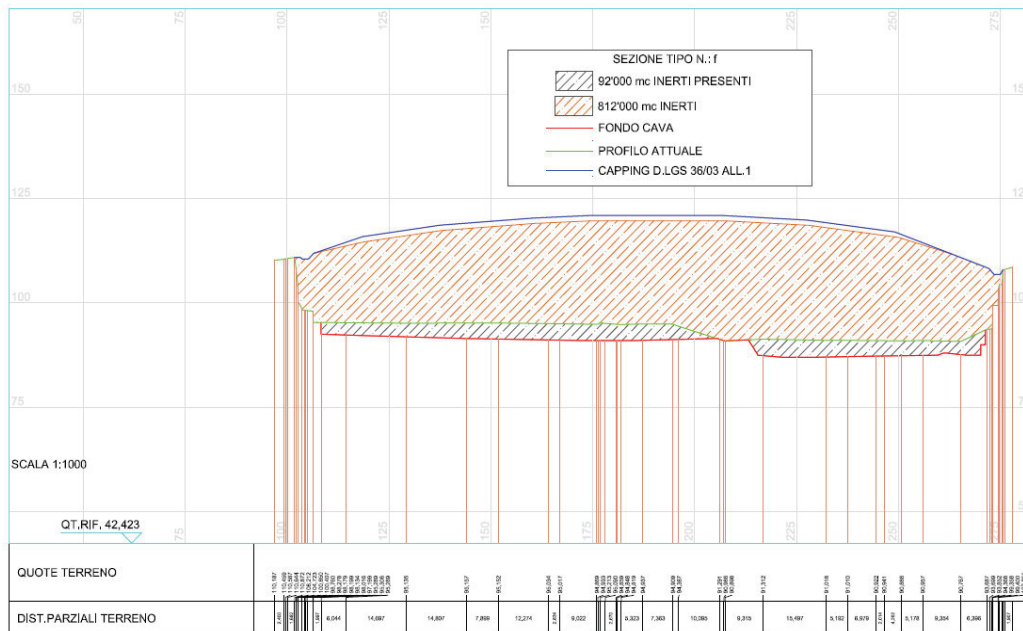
Stralcio della tavola allegata con il profilo di chiusura
